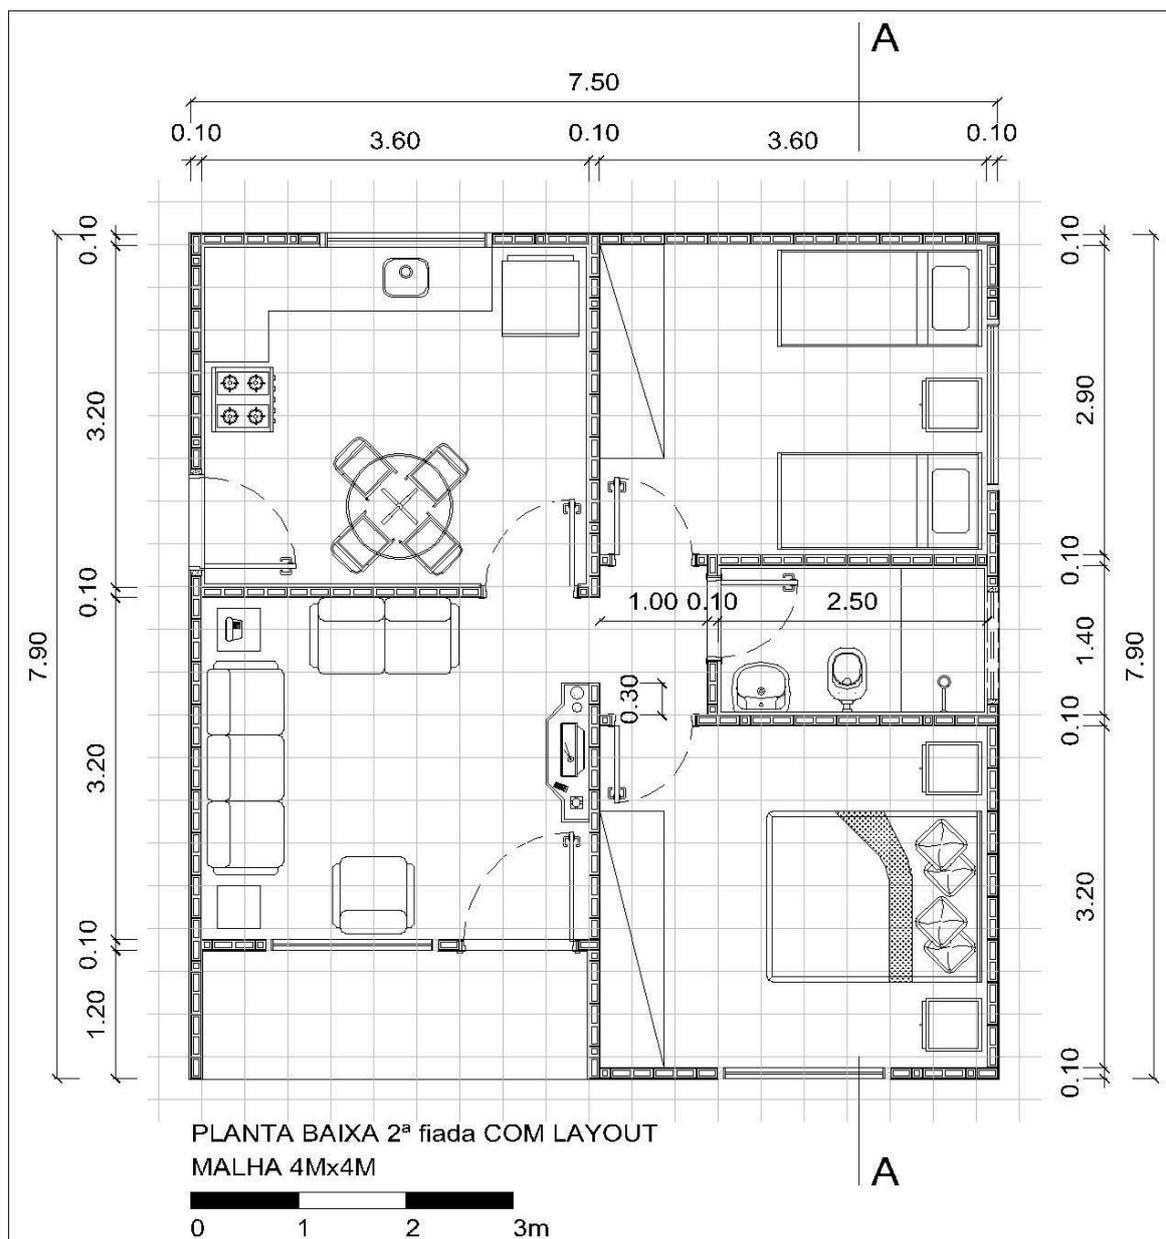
Planta Baixa 2ªfiada com Layout, malha 4Mx4M. Fonte: desenho da autora.
